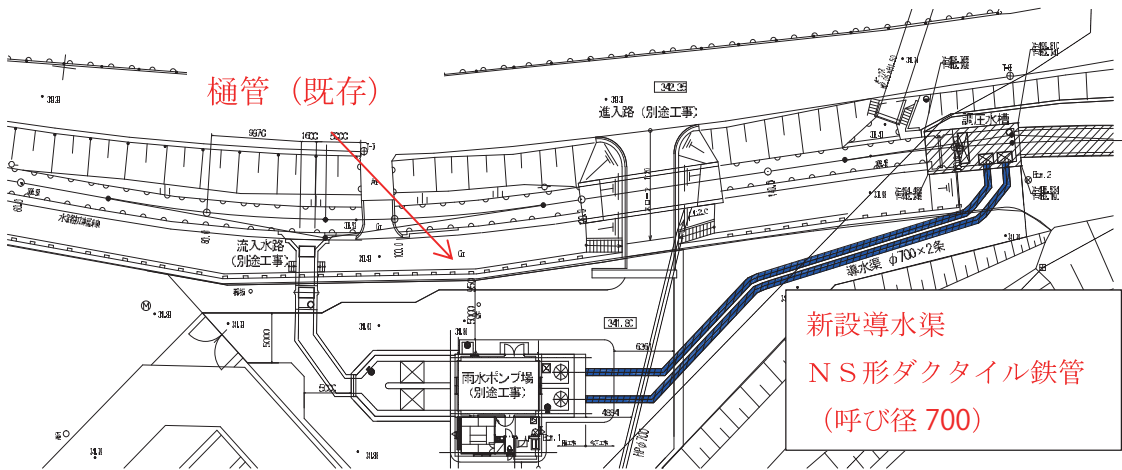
大豆島ポンプ場導水渠の工事概要図(平面図)
